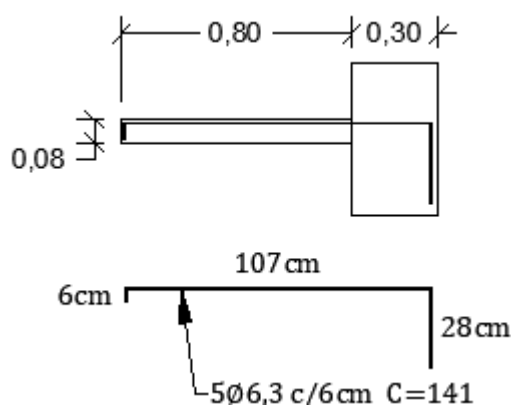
Vista lateral de um degrau da escada engastada com degraus isolados. Apresenta o detalhamento das armaduras longitudinais de flexão. As medidas estão apresentadas em metros (Fonte: autor).
